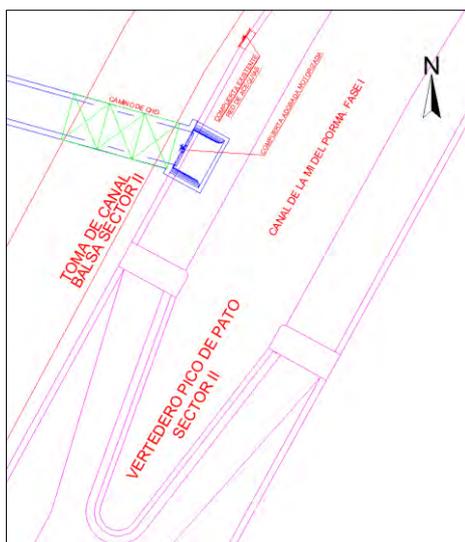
Vista en planta de la obra de toma a balsa del sector II aguas arriba del pico-pato.
